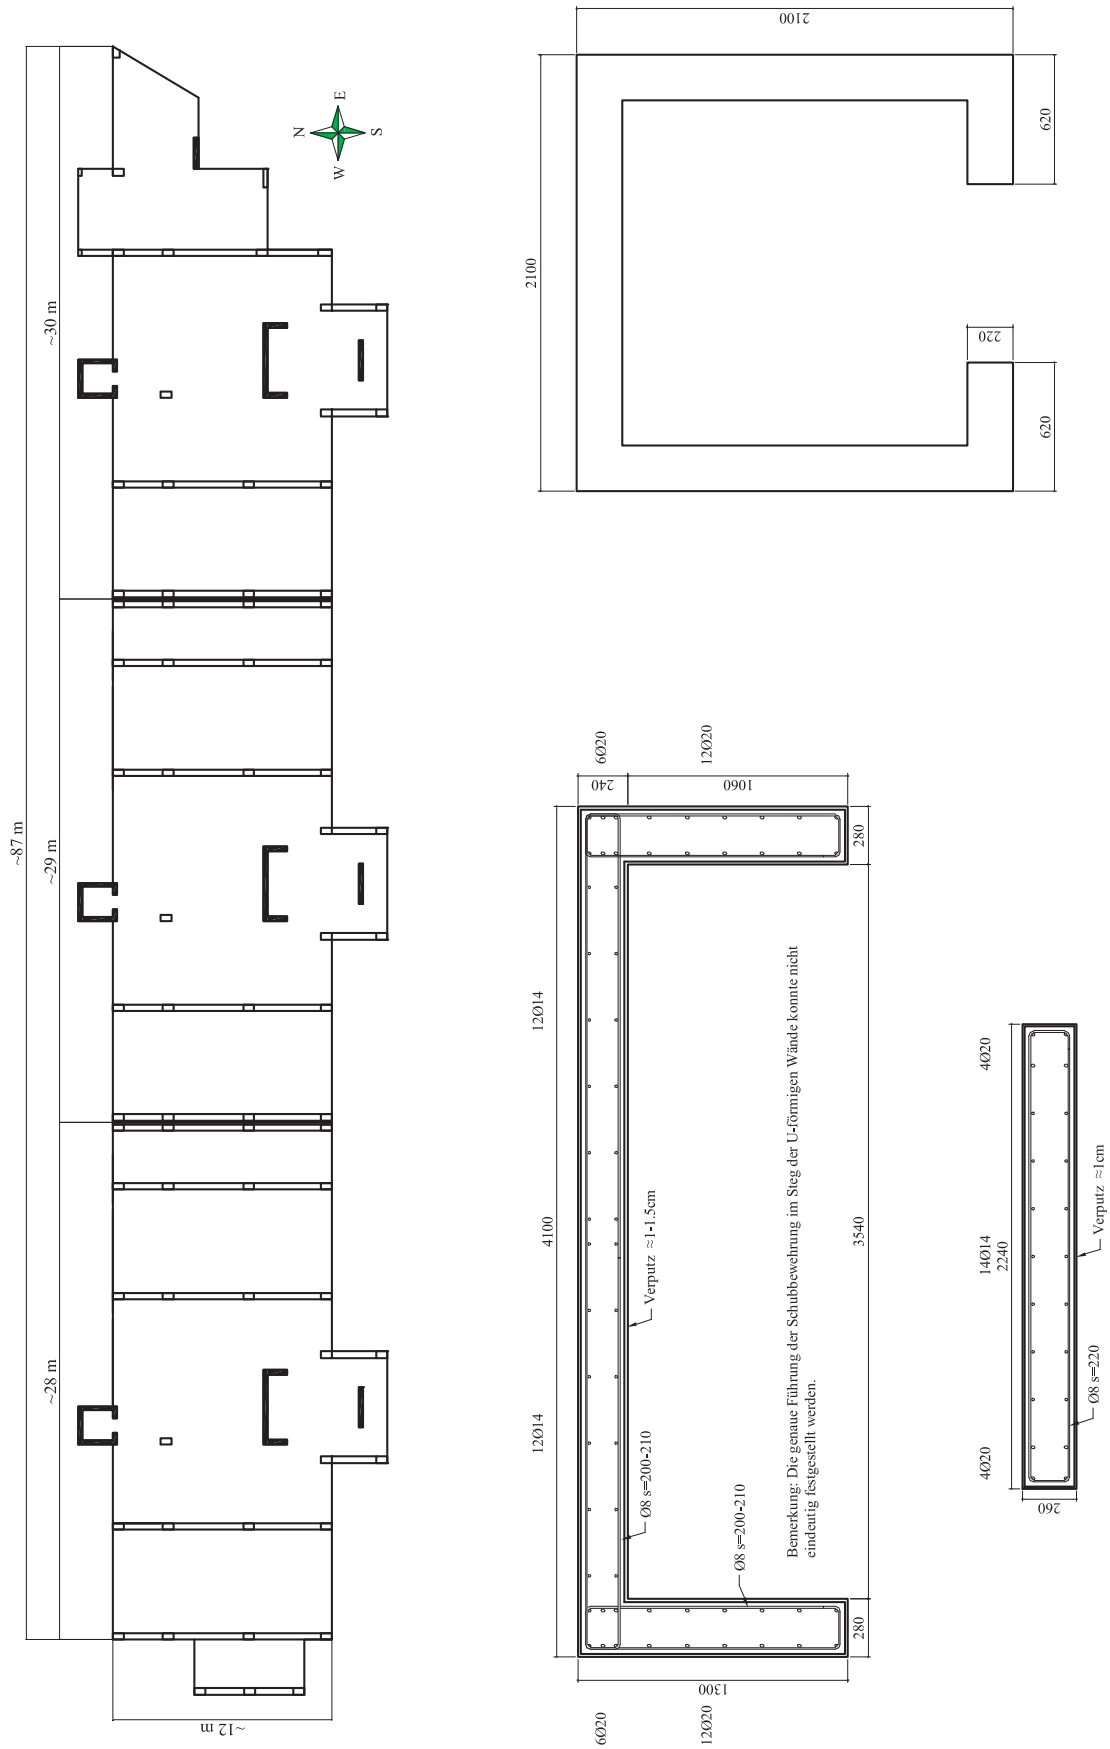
Skizze des Grundrisses und Querschnitte der Stahlbetonwände (i.d.R. Abmessungen in [mm])
